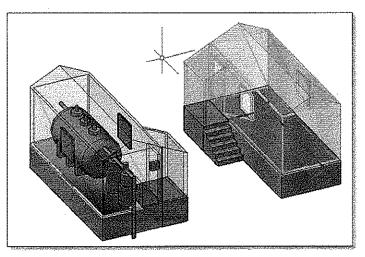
Esquema Planta de Tratamiento Aguas Servidas.
